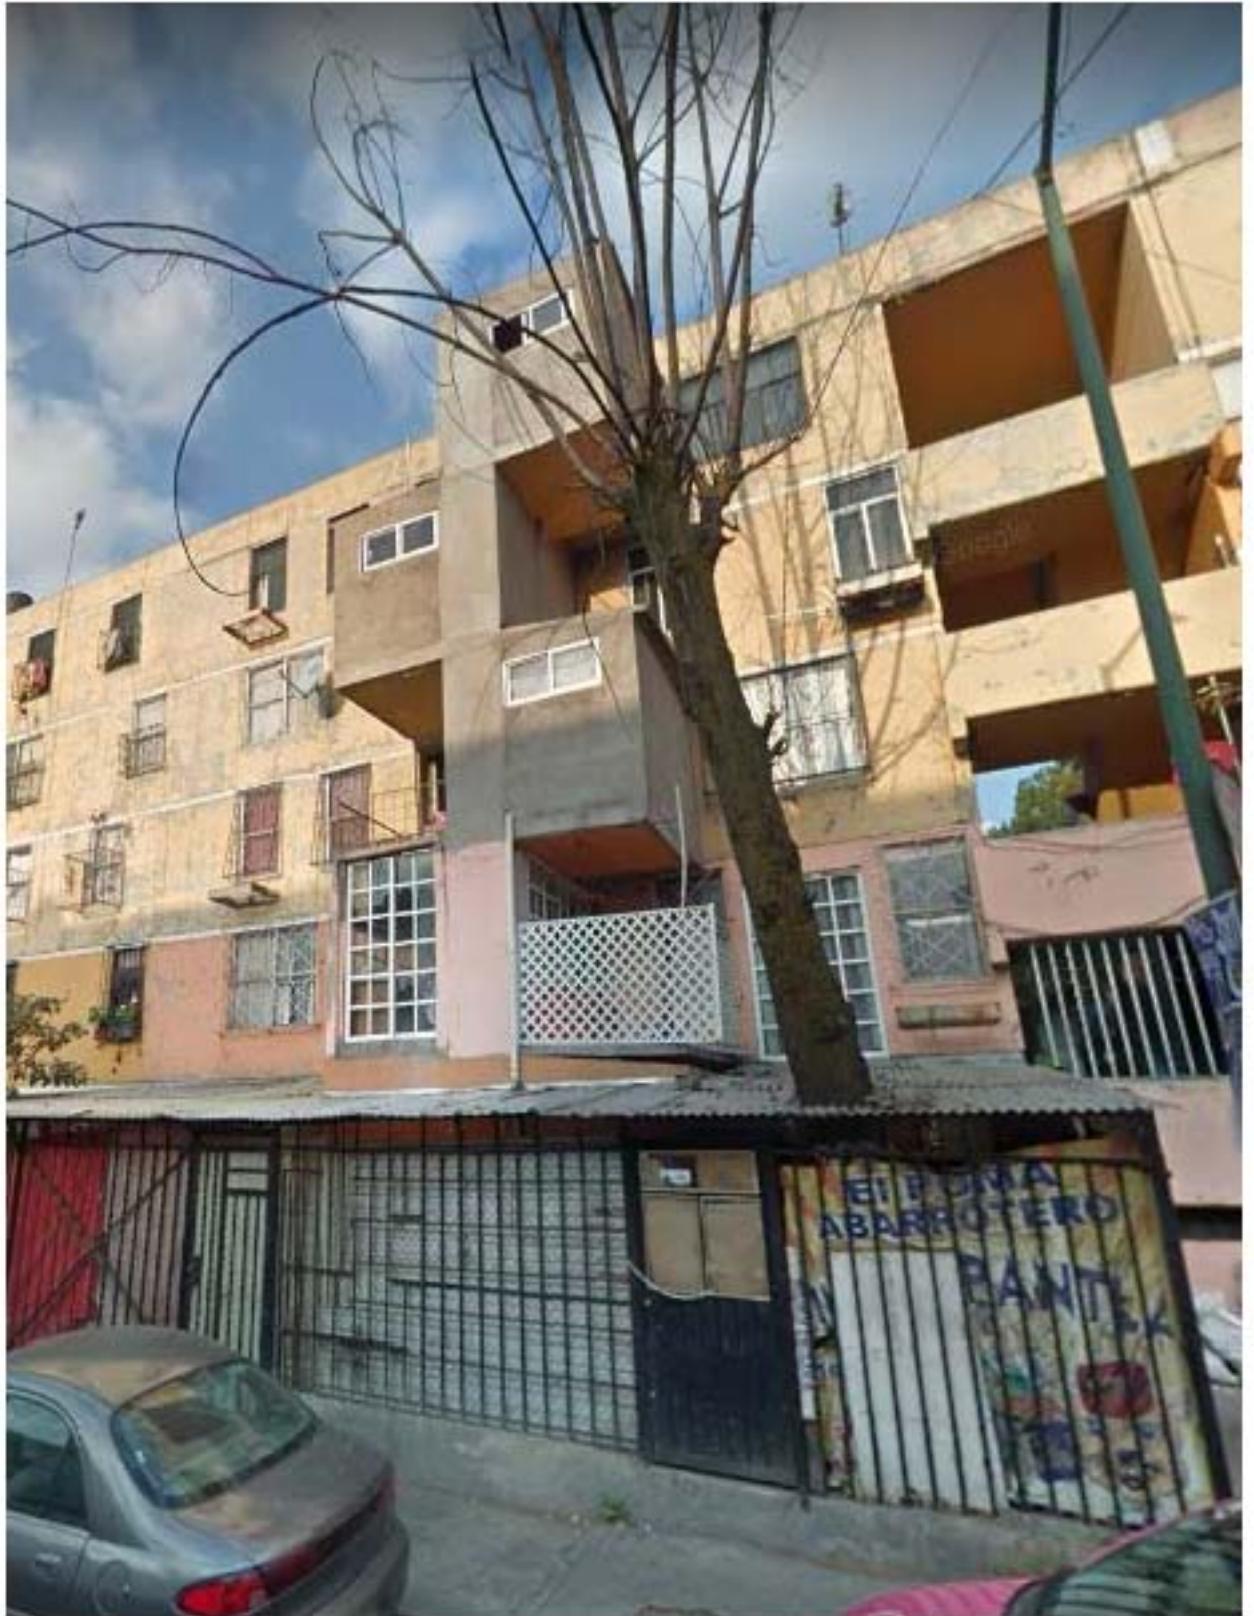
Fotografía de Acercamiento 3 al estado actual de Edificio C5
